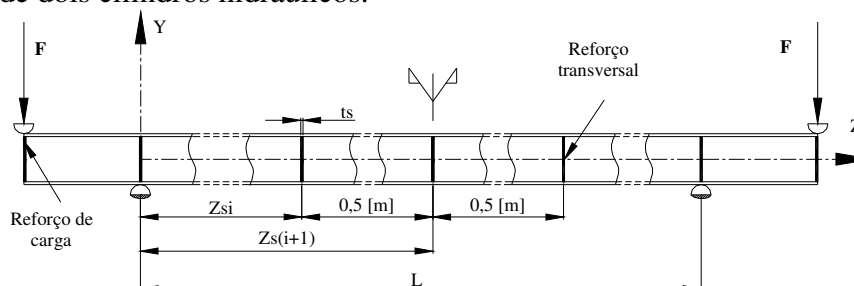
Modelo da geometria da viga com alma reforçada transversalmente.
